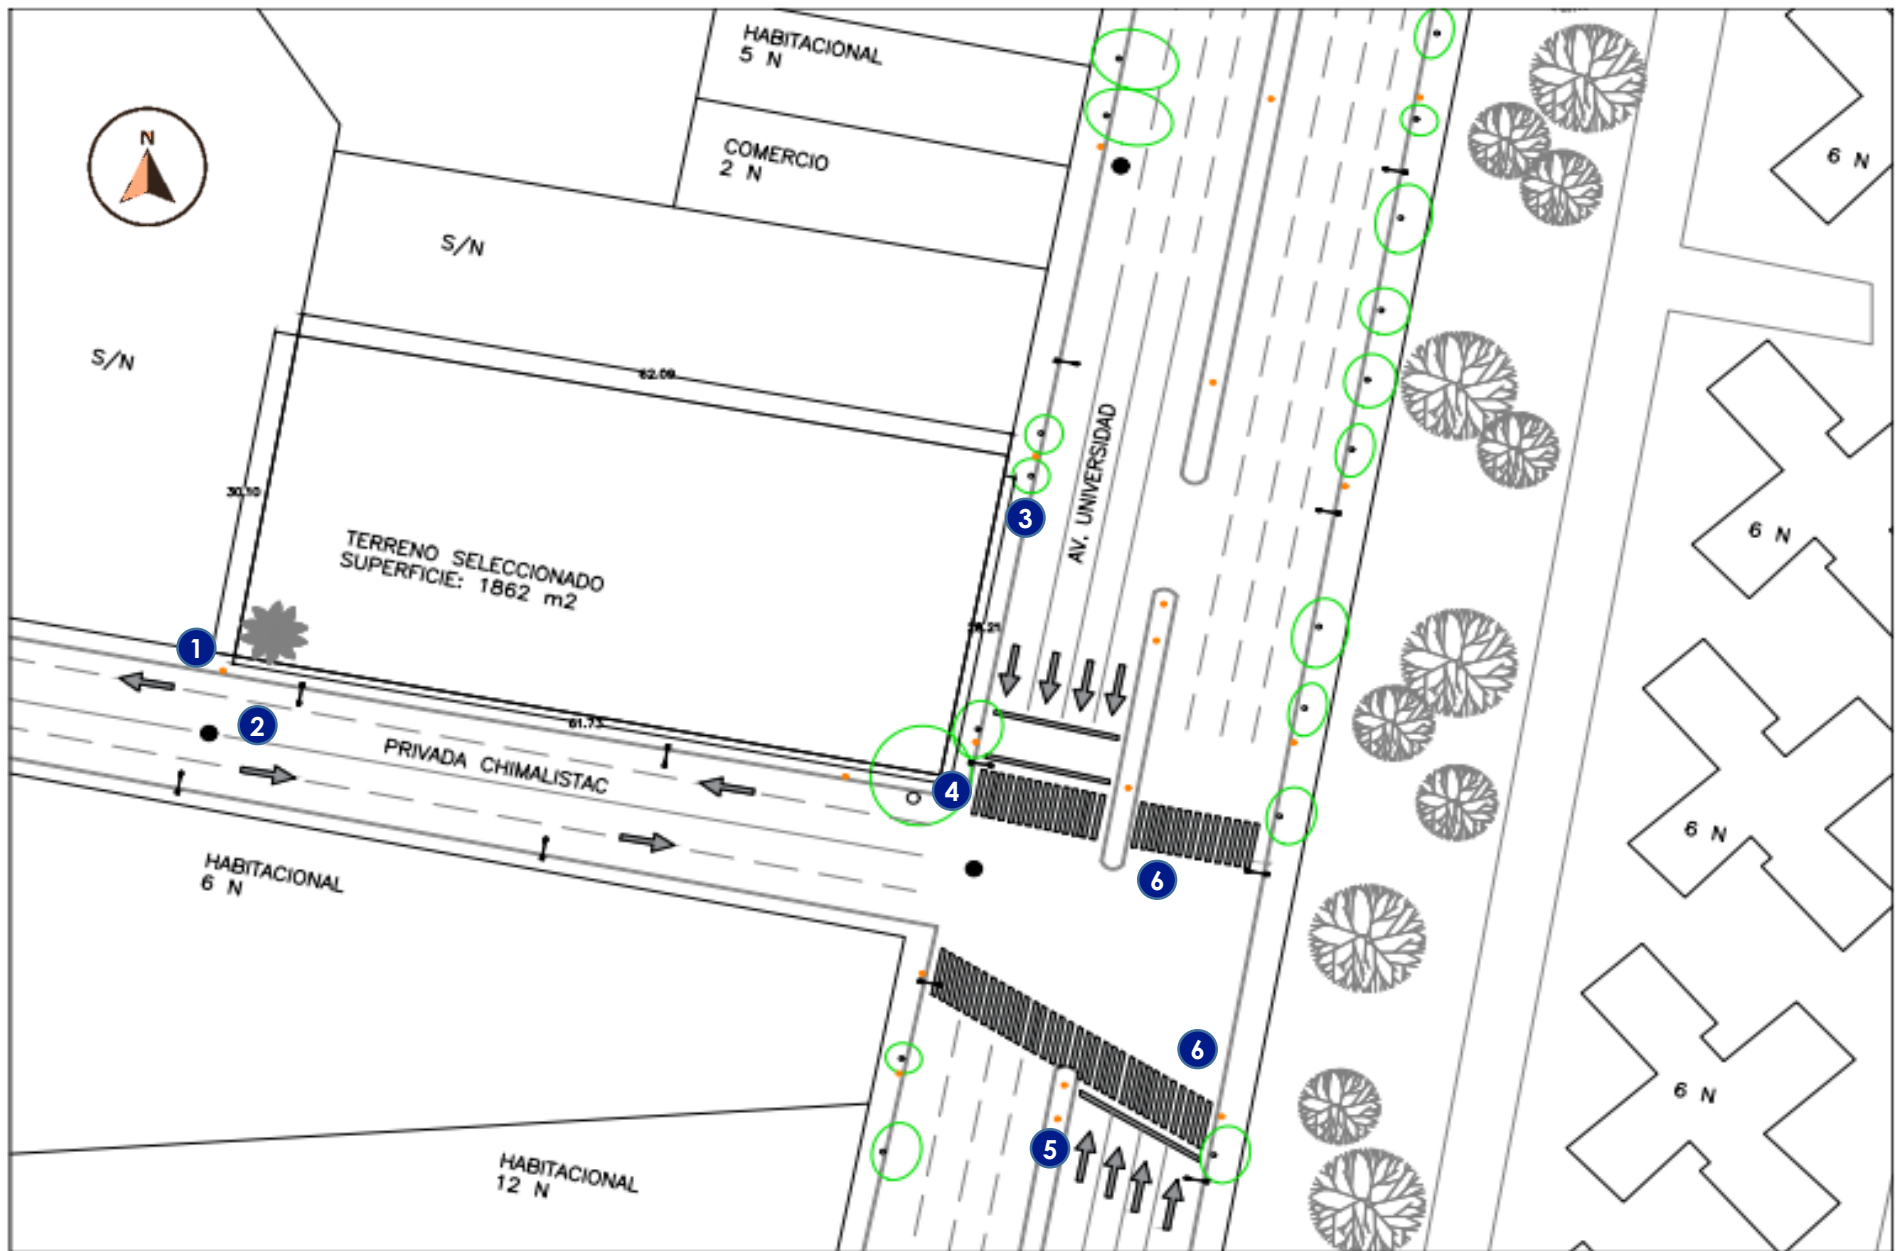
Levantamiento de la infraestructura del sitio. Elaboración propia.
